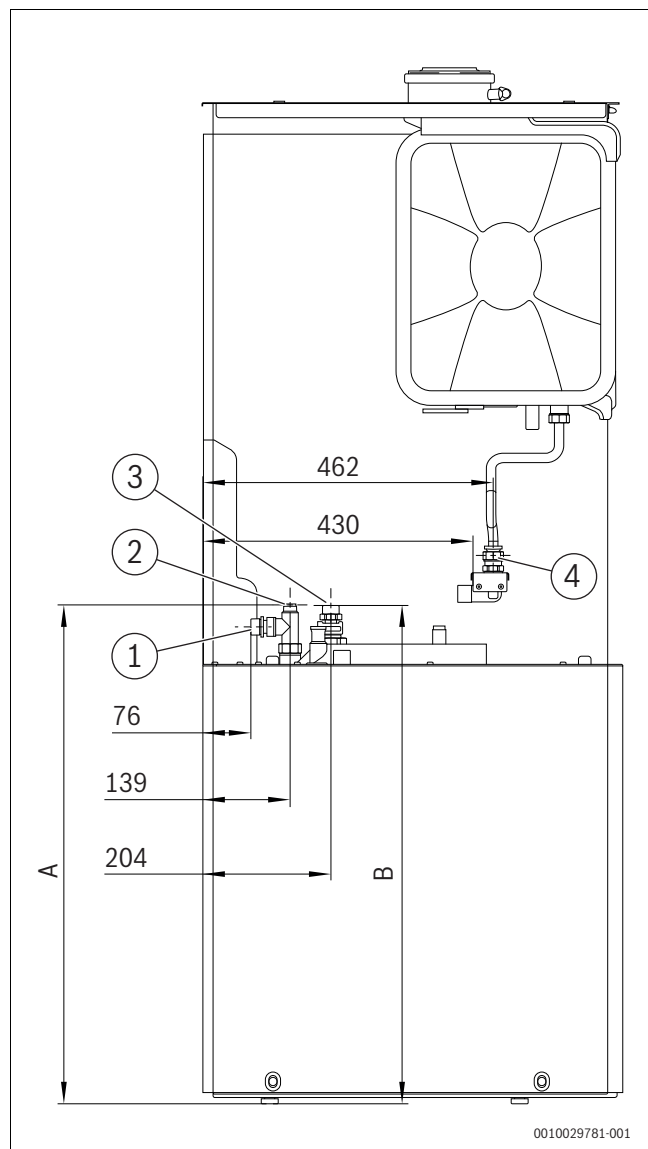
Pohled ze zadní strany (rozměry v mm)
